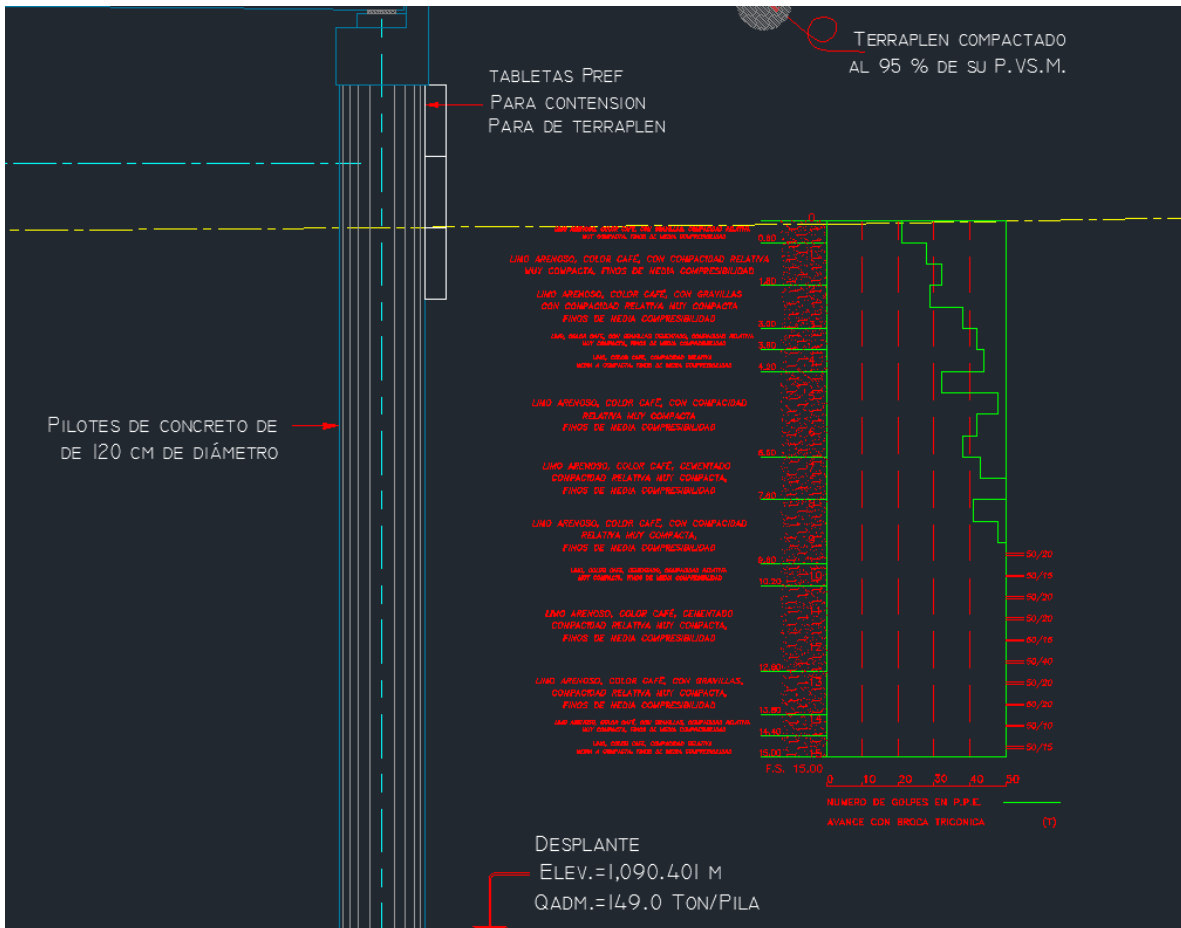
Estratigrafía de la zona donde se construirán los pilotes. Tomado del plano del proyecto (Anexo 1).
